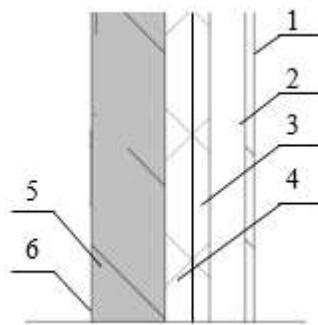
Схема влаштування зовнішніх стін будівлі дитсадка: 1- кlinkерна плитка, 2- вентильований повітряний прошарок, 3 – теплоізоляція мінеральна вата, 4 – керамічна цегла, 5 – внутрішня цементно-піщана штукатурка
